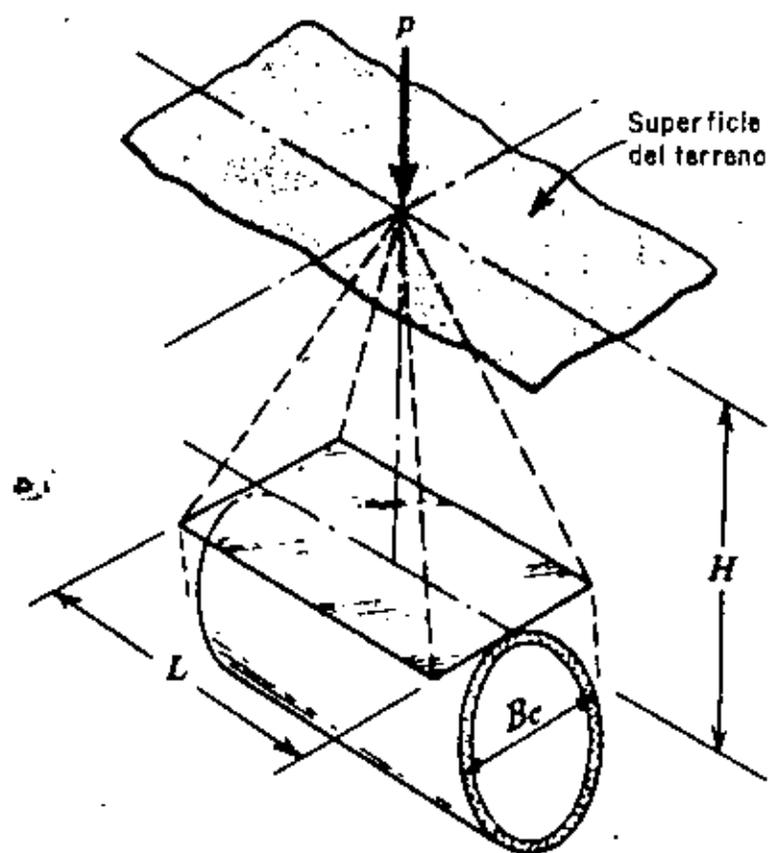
CARGA CONCENTRADA SOBREPUESTA CENTRADA VERTICALMENTE SOBRE EL CONDUCTO.
